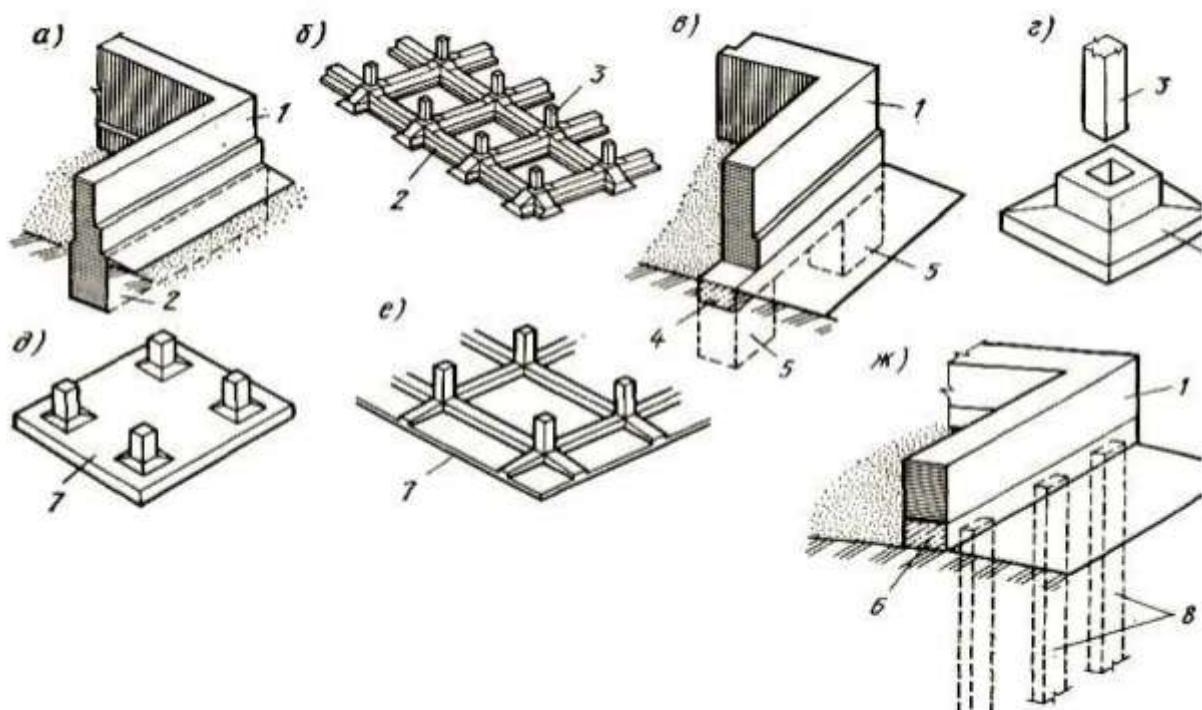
Конструктивные схемы фундаментов: а - ленточный под стены; б - ленточный под колонны; в - столбчатый под стены; г - столбчатый по колонну; д - сплошной безбалочный; е - сплошной балочный; ж - свайный; 1 — стена; 2 — ленточный фундамент; 3 — железобетонная колонна; 4 — железобетонная фундаментная балка; 5 — столбчатый фундамент; 6 — ростверк свайного фундамента; 7 — железобетонная фундаментная плита; 8 — сваи.
